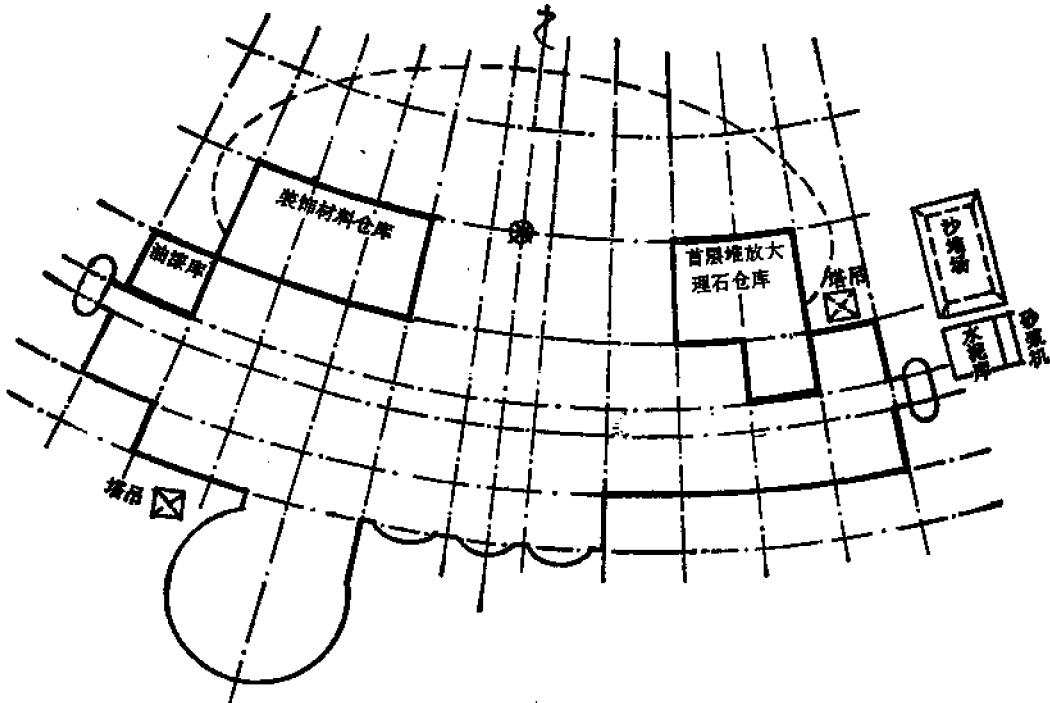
(3) 上海太平洋大饭店施工平面布置图
